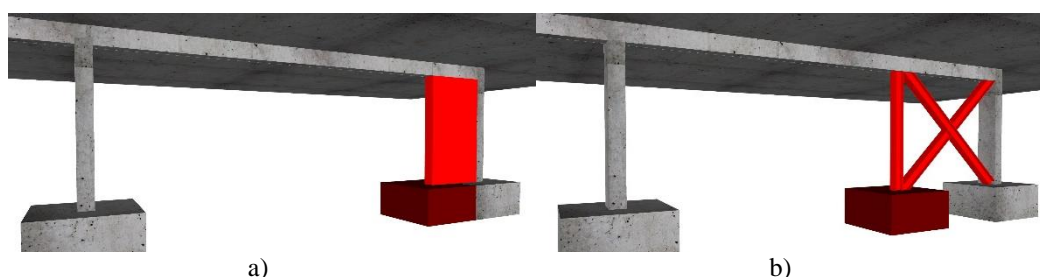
Reforço por alteração estrutural tendo em vista o reforço aos sismos; a) Construção de parede de betão armado, incluindo o reforço da fundação; b) Construção de fundação e montagem de estrutura metálica [26].
